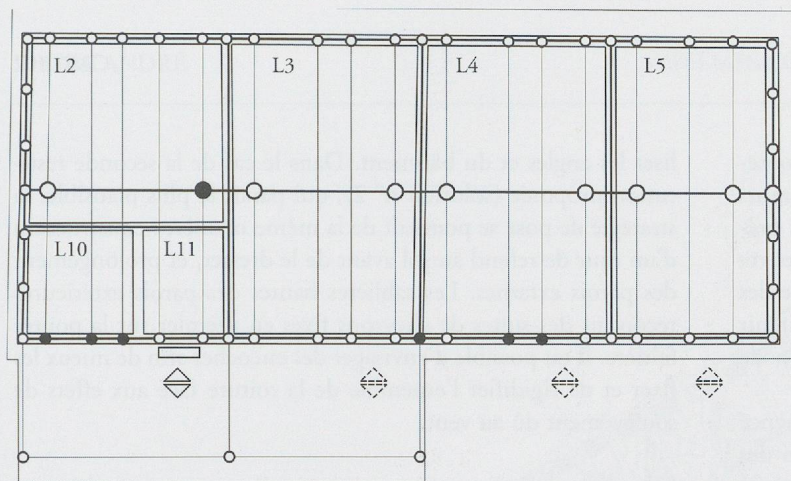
Parcelle B, bâtiment ouest (locaux 2-5, 10-11) (état 4b). Type : enfilade de pièces. Plan et élévations schématiques. Conventions graphiques :
